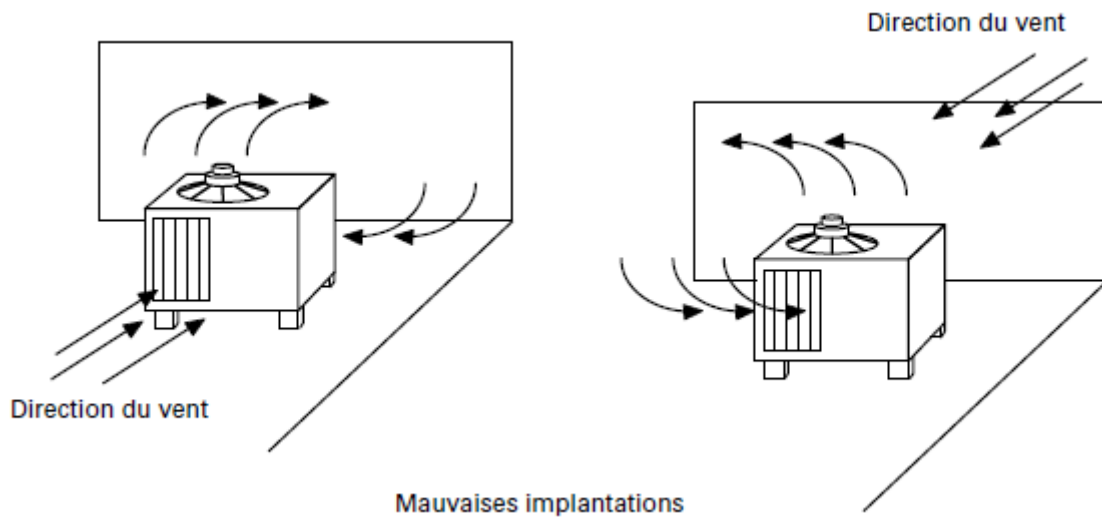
Recyclage parasite d'air extérieur sur la pompe à chaleur
